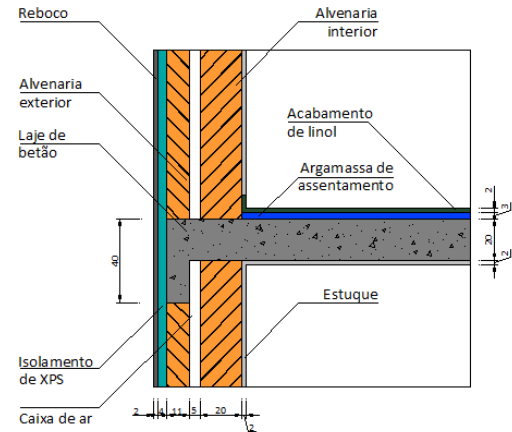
Pormenor construtivo com isolamento pelo exterior do edifício VII.
